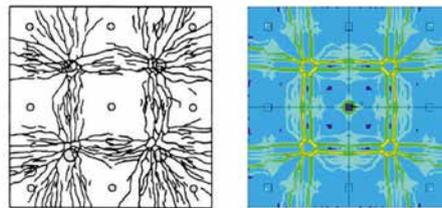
Rissbilder einer Betonplatte anhand eines Versuchs (links) sowie durch die Berechnung mit dem Drucker-Prager Concrete Modell (rechts).
